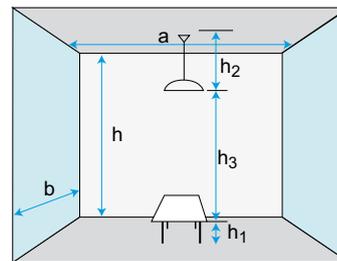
Dimensions du local, plan des luminaires et plan de travail
